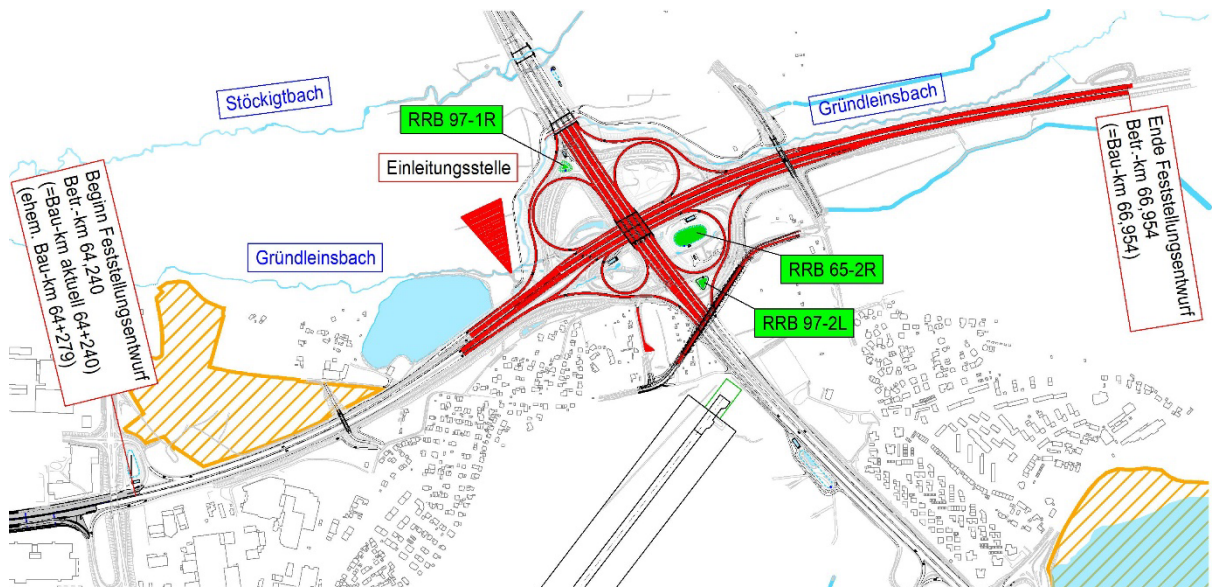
Einleitung in den Gründleinsbach, Planung
